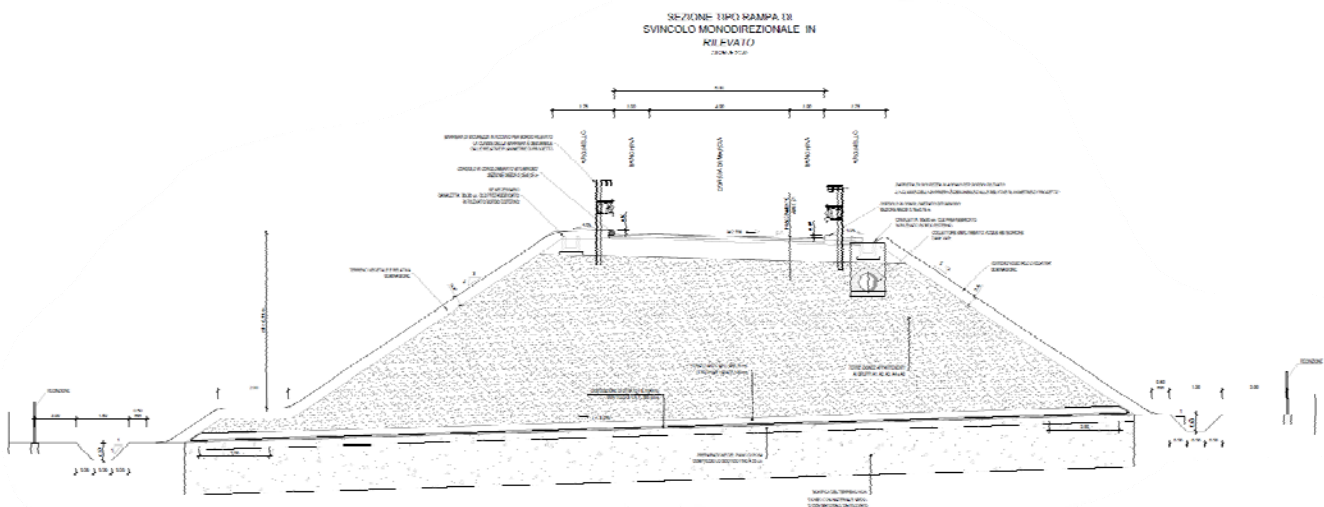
Sezione tipo in rilevato rampa di svincolo
